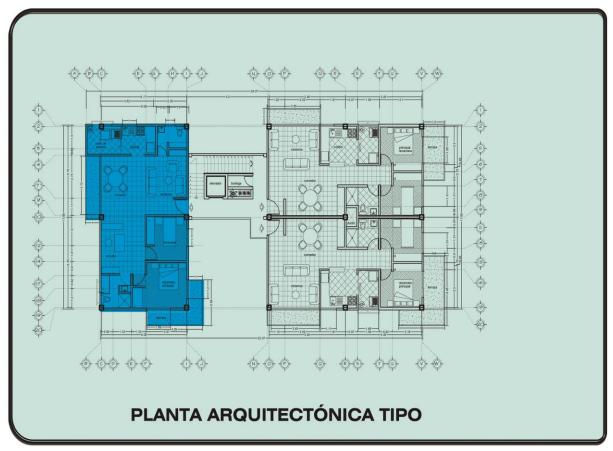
PLANTA ARQUITECTÓNICA DEPARTAMENTOS TIPO A
